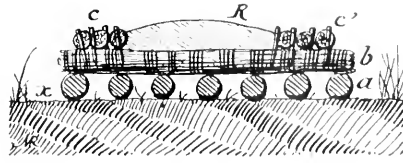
Coupe en travers d'une chaussée en terrain marécageux.
